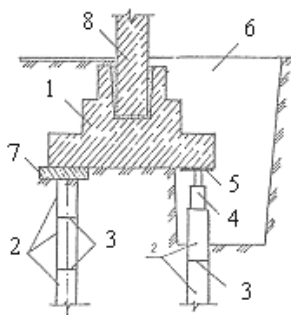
Передача нагрузки от фундамента на короткие железобетонные сваи, погружаемые вдавливанием:
